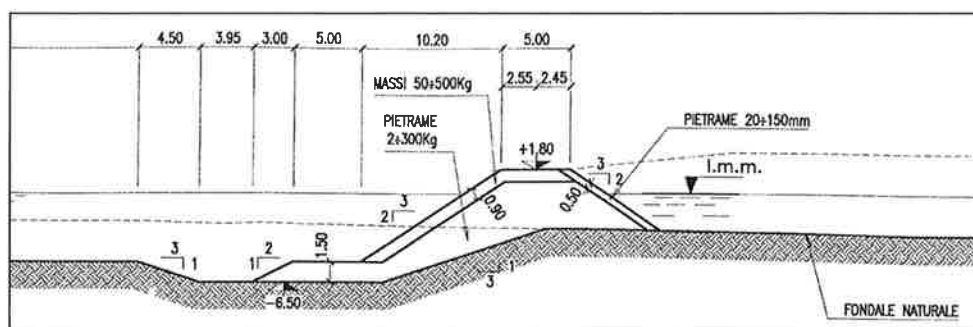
CONTERMINAZIONE DELL'ISOLA LUNGO IL FRONTE LATO LAGUNA: SEZIONE TIPO
